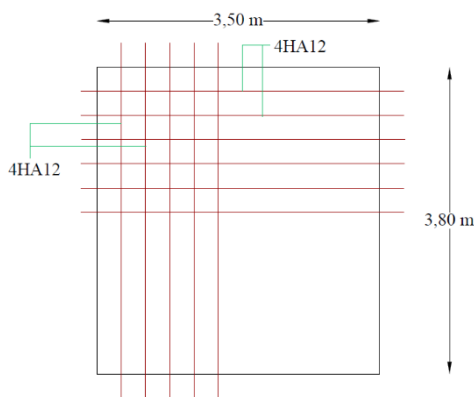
Schéma du ferrailage en travée des dalles. (Nappes inférieures).
